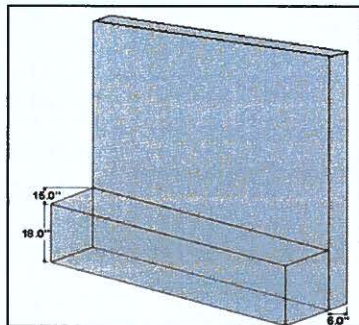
Obra Civil Para Instalación de Paneles en ausencia de muros
